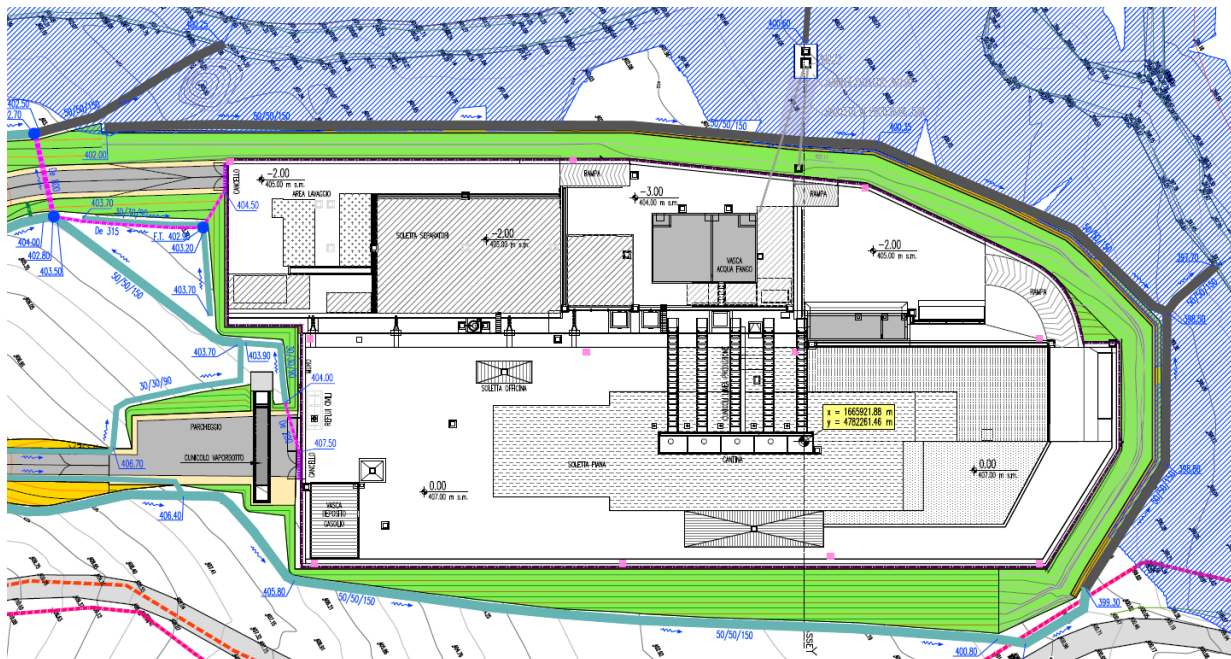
Planimetria di progetto della rete idraulica di intercettazione ed allontanamento delle acque esterne alla postazione (stralcio fossi in massi cementati).
